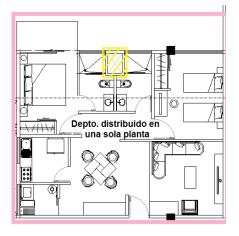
Ubicación de ducto de instalaciones en departamento tipo de una planta.
